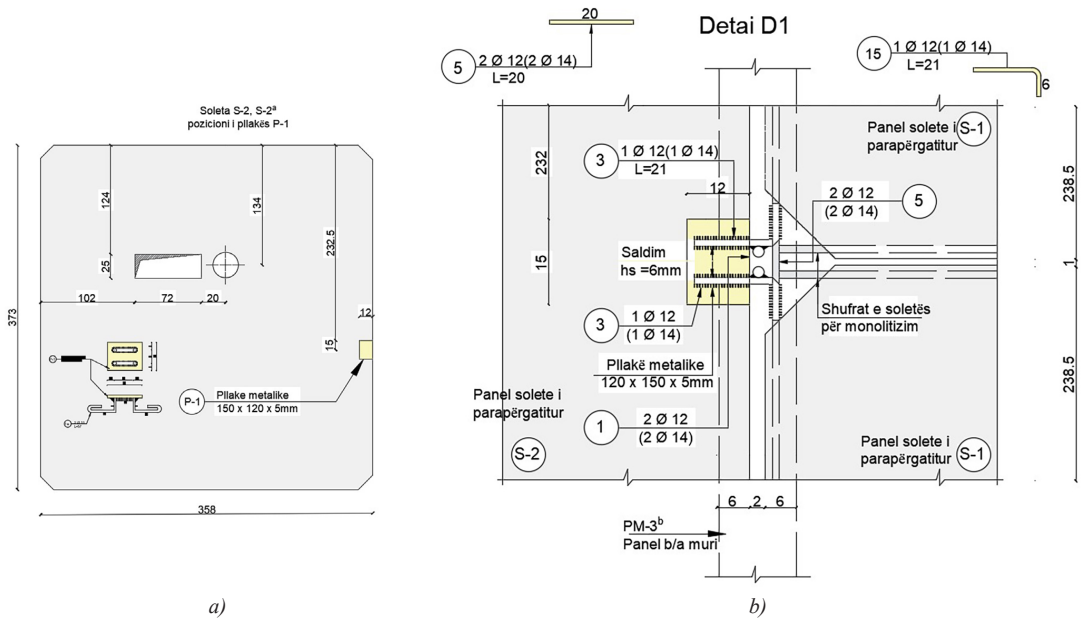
Lidhjet e pllakave të soletave: a) plani i një pllake që tregon vendndodhjen e lidhjes (P-1) dhe b) detajin e një bashkimi midis paneleve të pllakave ngjitur (seksioni horizontal).
